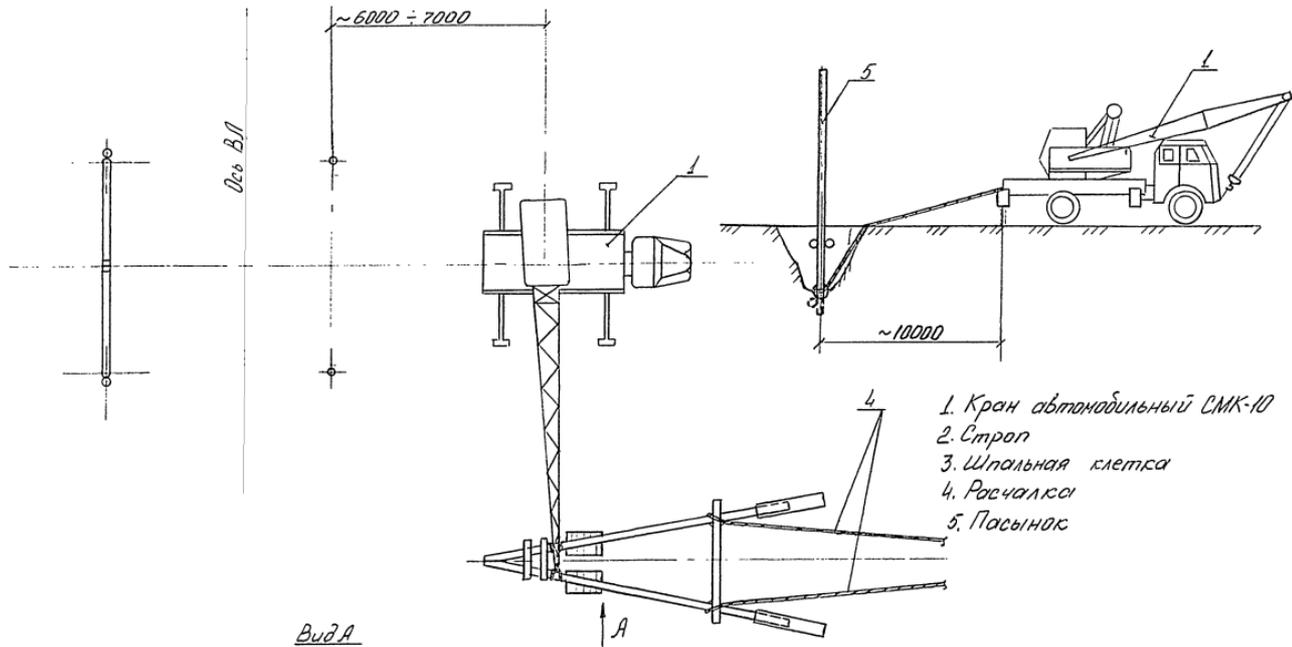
Вариант 2. Демонтаж опоры по частям. Укладка А-образной фермы на землю и извлечение пасынка из земли
